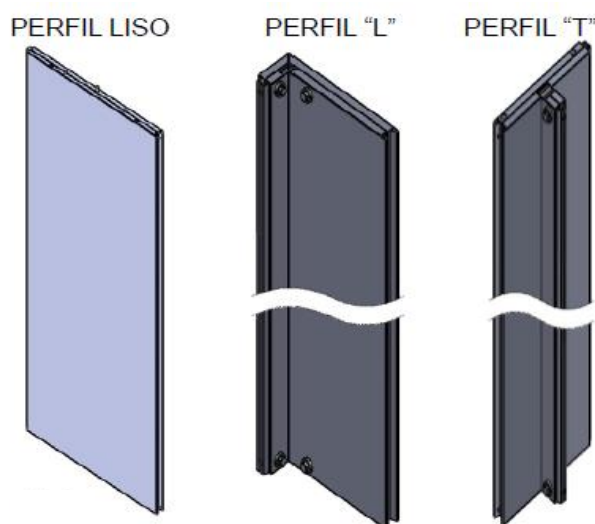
Tipos de painéis sanduíche (perfil liso / perfil “L” / perfil “T”).
